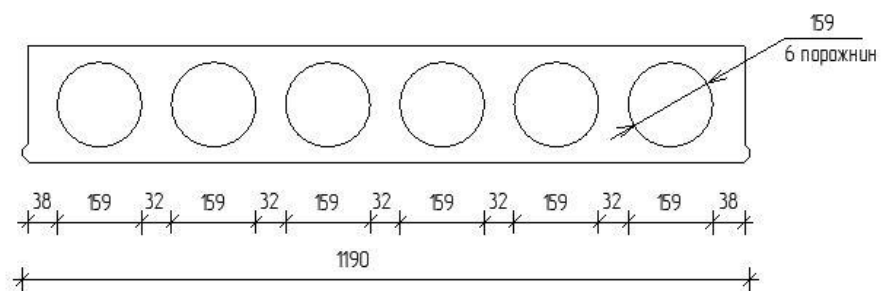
Поперечний переріз багатопустотної плити перекриття
